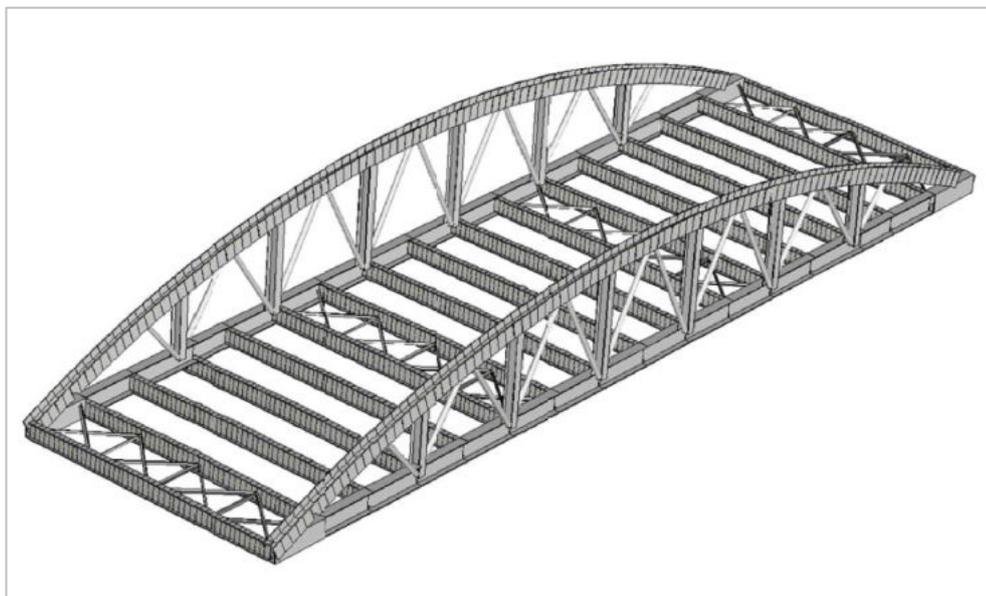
/1 Ponte sulla ferrovia – Vista assonometrica della struttura
